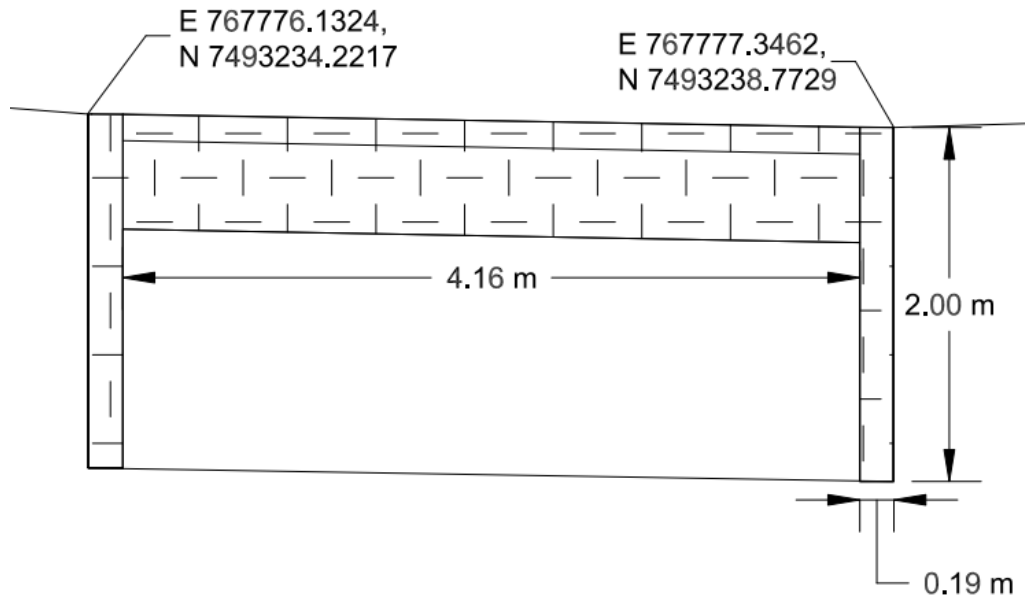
Obstrução 2 levantada no Valão da Caixa. Coordenadas da vista de montante em projeção UTM sistema de referência SIRGAS 2000.
